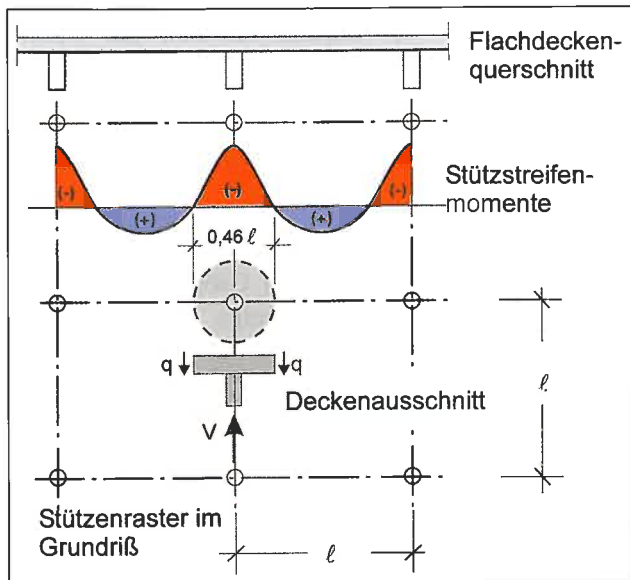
Flachdeckensystem und Deckenausschnitt zur Untersuchung des Durchstanzwiderstandes
